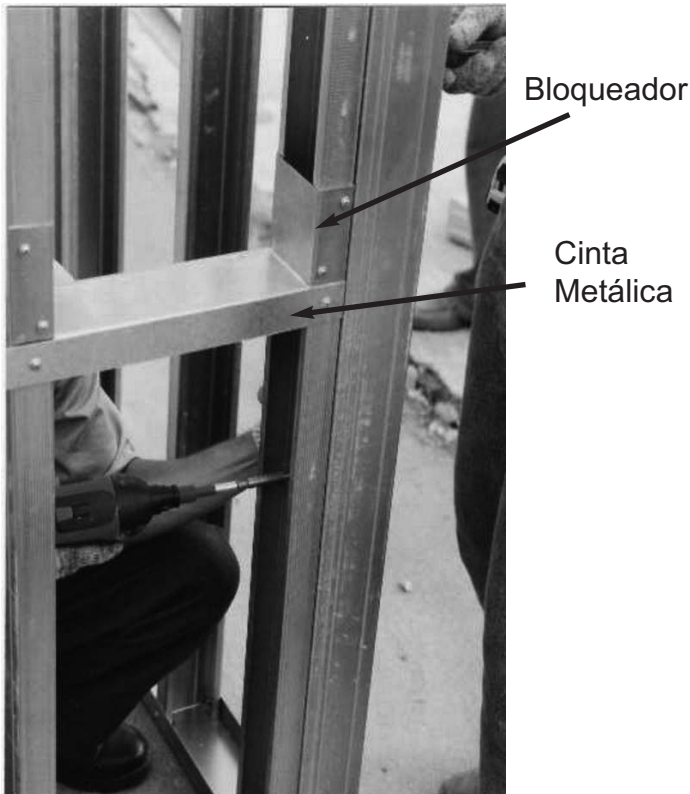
Bloqueador y cinta de acero galvanizado fijados al panel para rigidización horizontal (Fuente: Archivo del autor)
